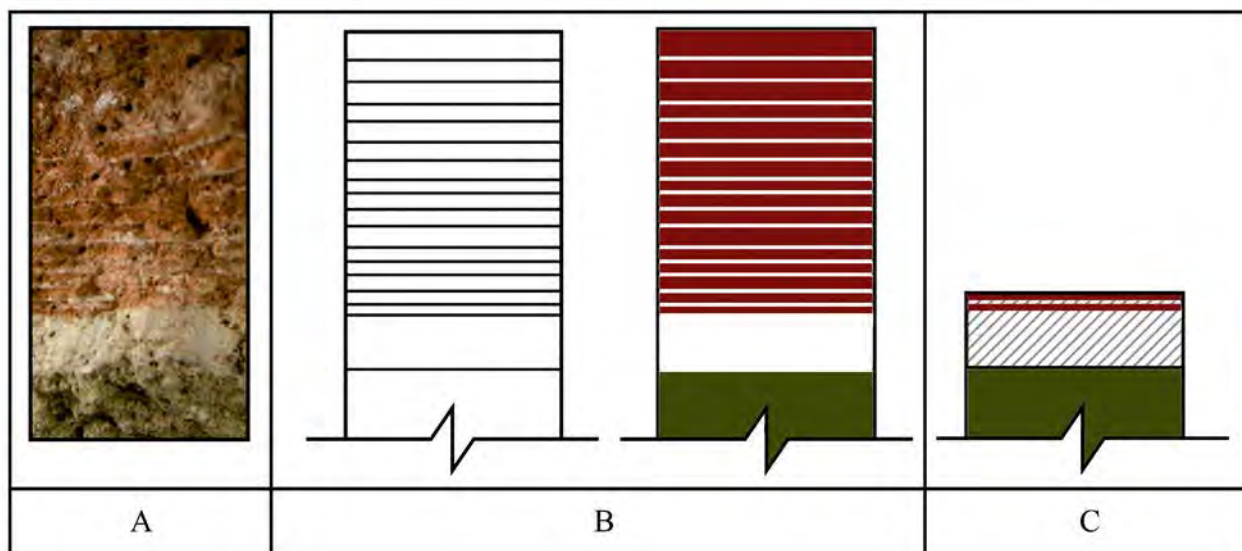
Propuesta del proceso de idealización de elementos constructivos. A) Fotografiado del pavimento de H-7, Cancho Roano A. B) Esquematzación de las distintas fases y reparaciones identificadas. C) Tipificación y caracterización del pavimento. Proyecto «Construyendo Tarteso».
